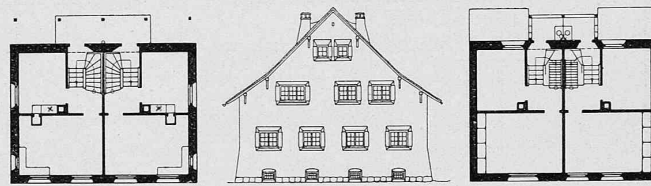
(oben) Ansicht, Abb. 7 Grundrisse und bahnseitige Fassade 1:400 eines Doppel-Einfamilienhauses auf Station Wiesen der Rh. B., erbaut 1911.
